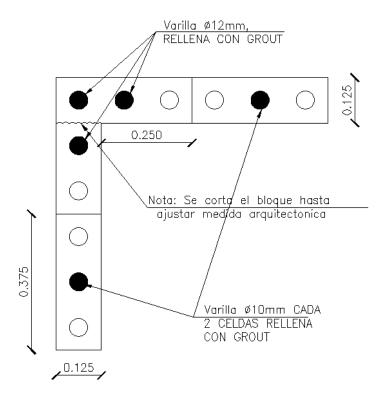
Vista en planta esquina en "L" segunda hilada
